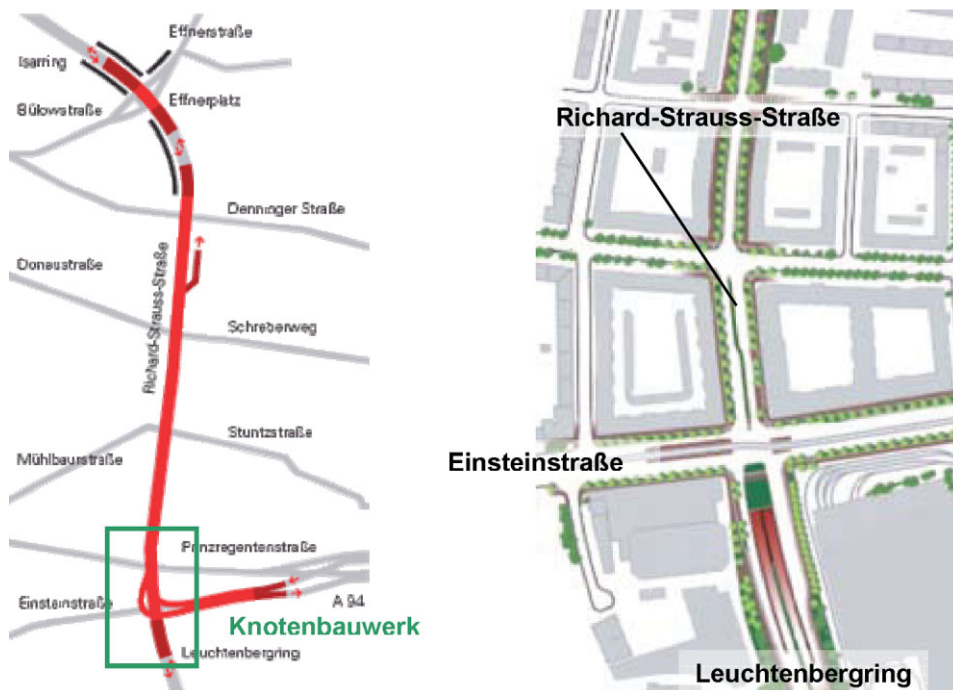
Tunnelverlauf, rechts Detailausschnitt des Kreuzungsbauwerks nach [12]
